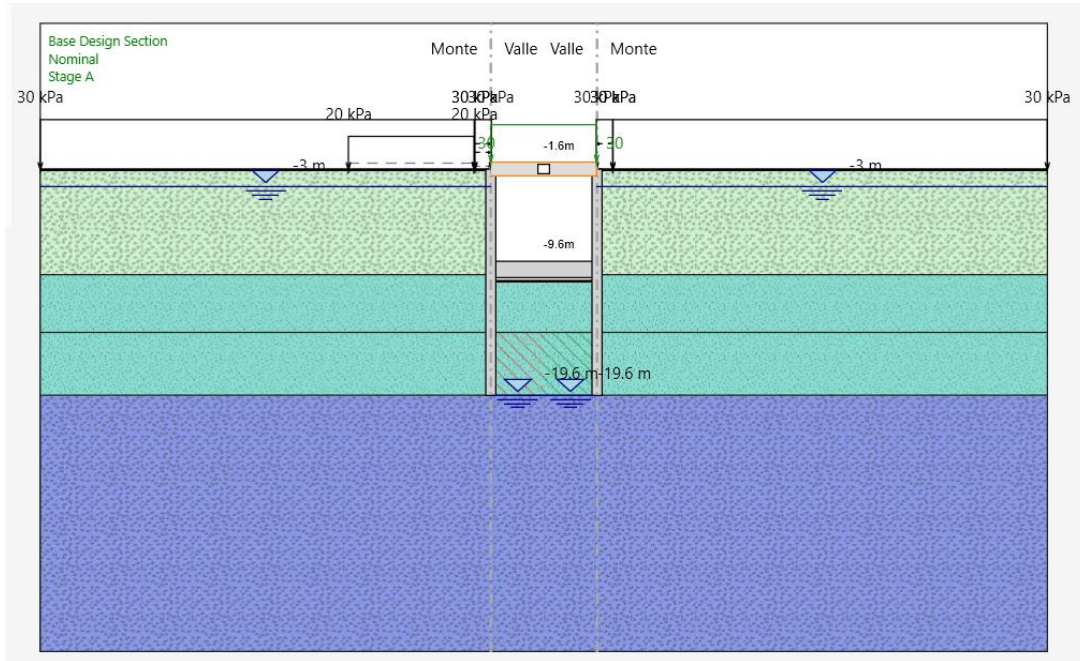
Fase 4 - Realizzazione della fondazione e riempimento
